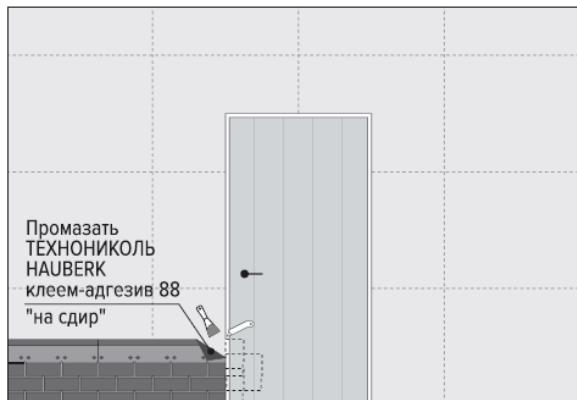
Монтаж фасадной плитки вокруг дверных проемов
